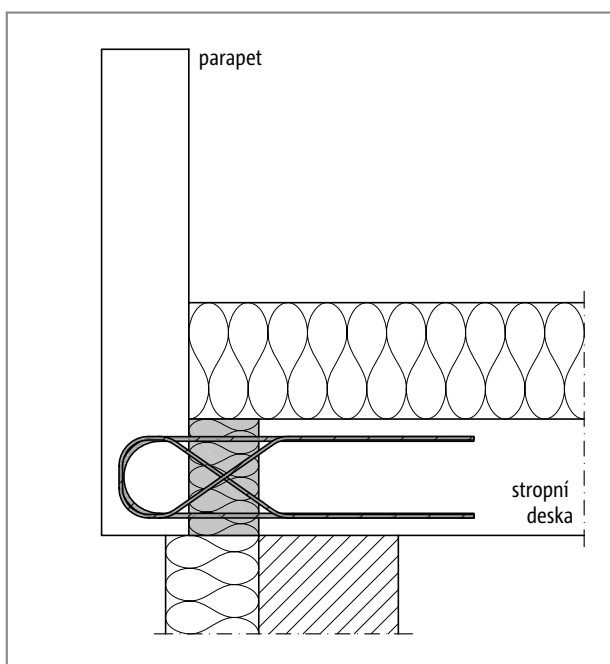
Schöck Isokorb® typ ABXT - svislé zabudování: Pohled, uložení parapetu resp. atiky na stropní desce
